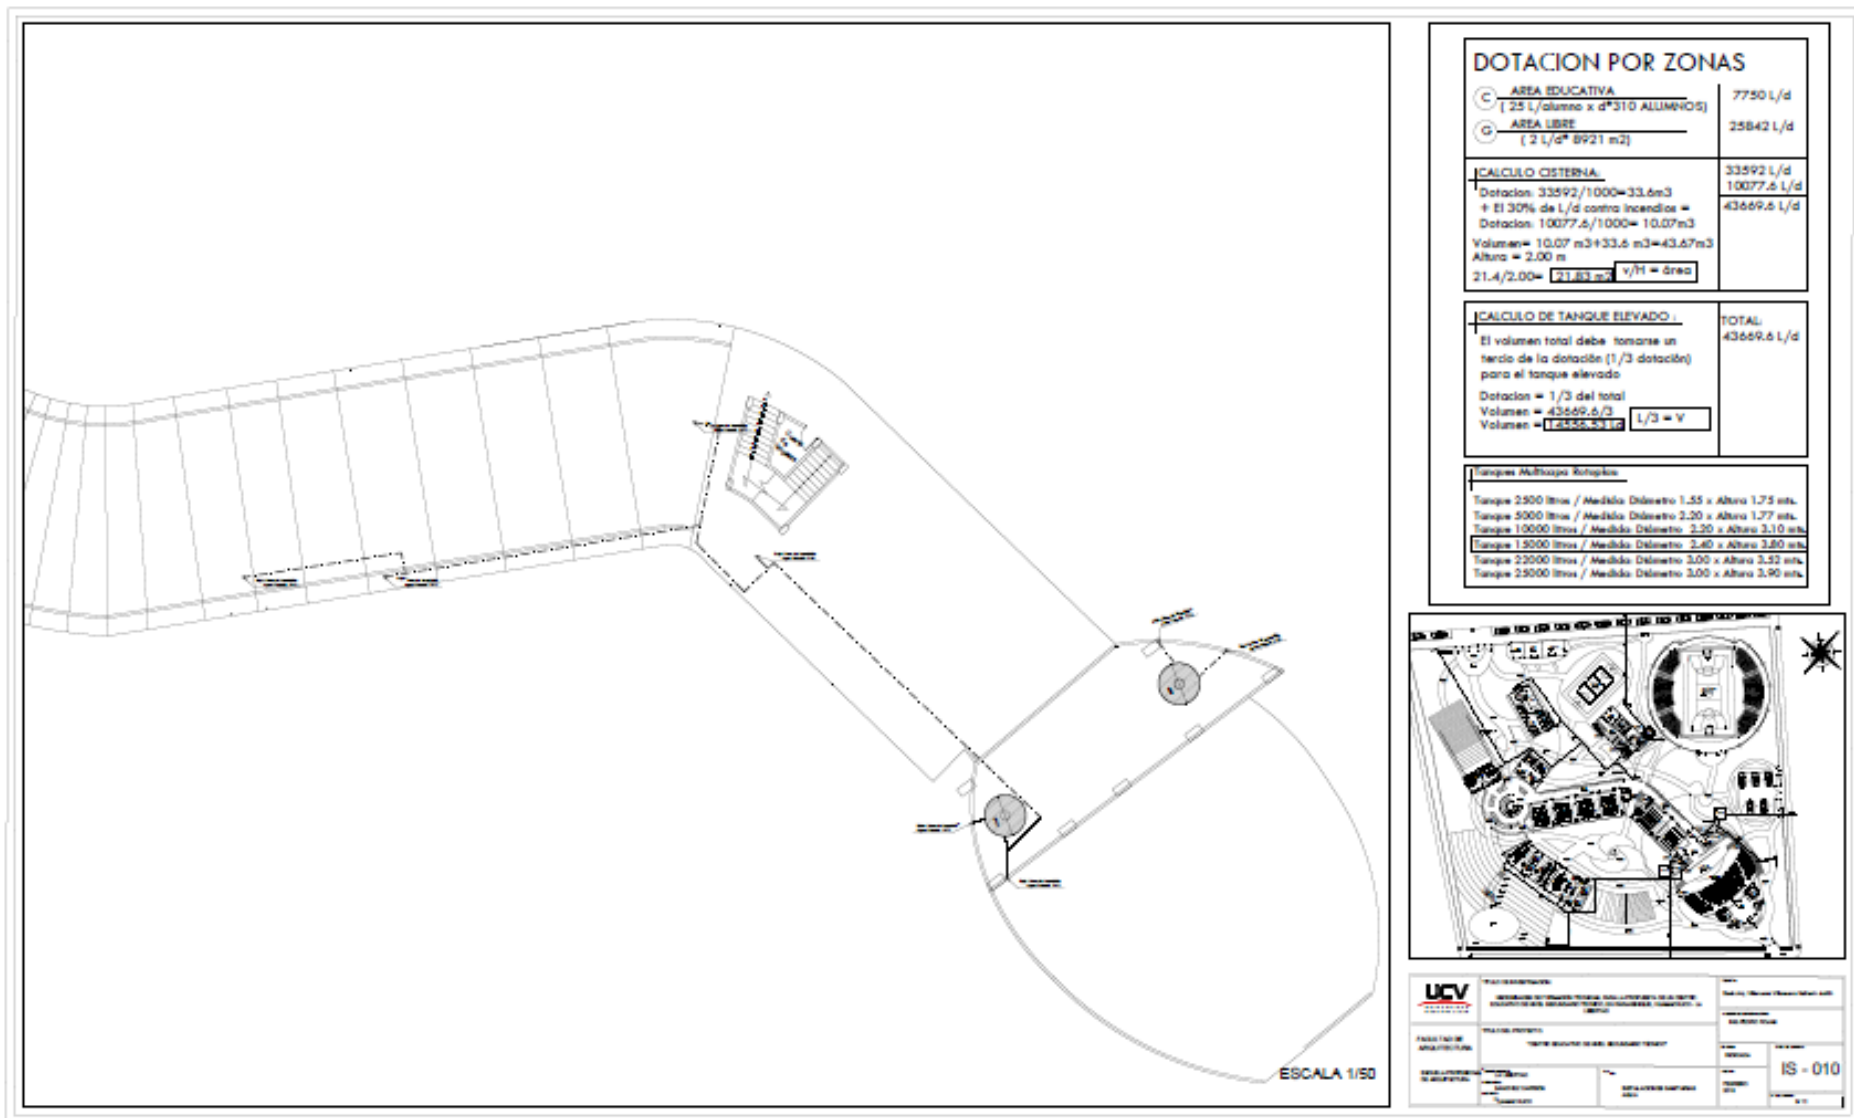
Plano de Diseño de Instalaciones Básicas Detalle – Agua - Plano N° 31 - Lamina IS-10
